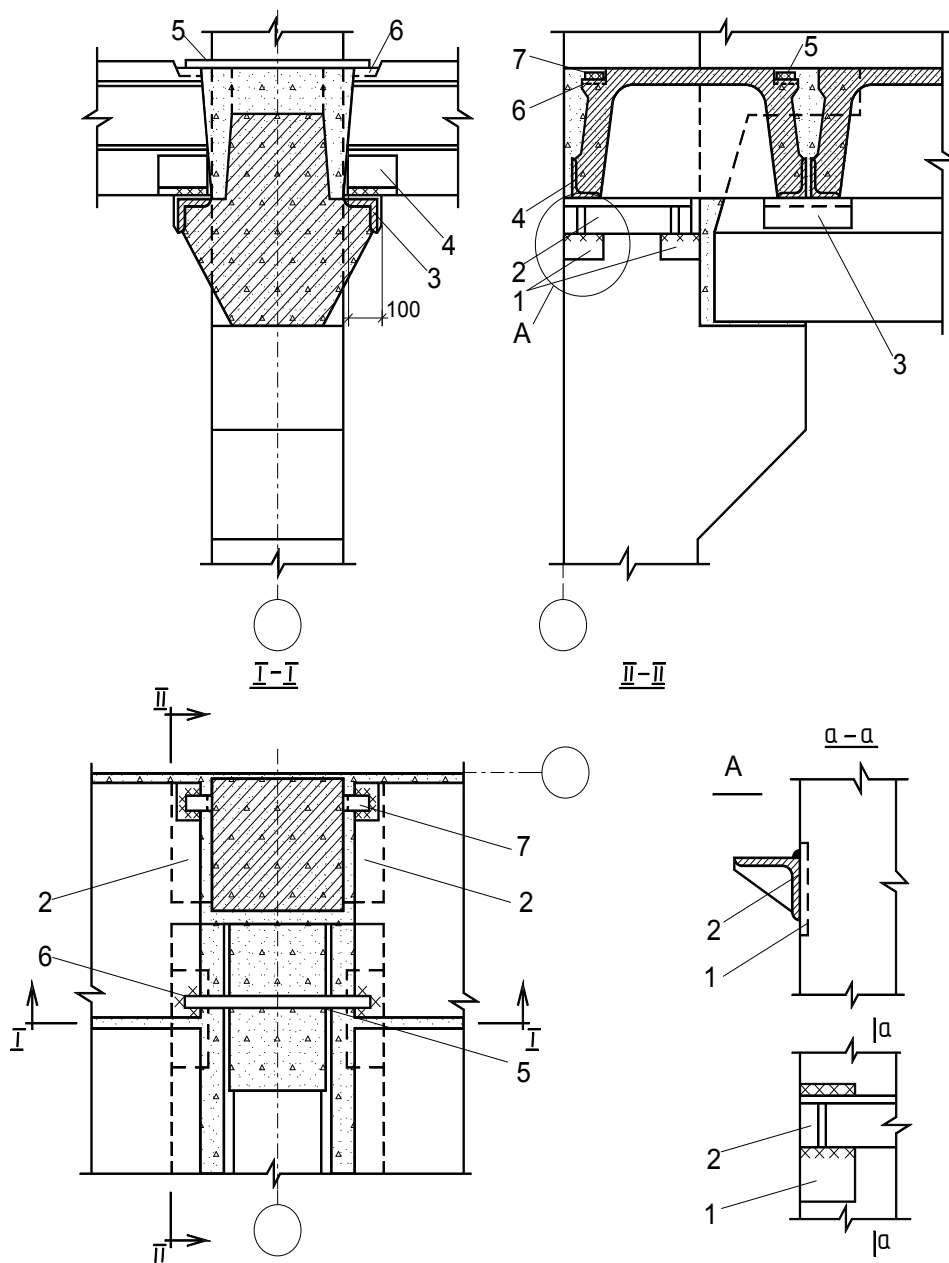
Деталі кріплення плит перекриття біля середньої колони при ригелях з полицями: 1, 3 – закладні деталі ригеля; 2 – столик з прокатного кутика; 4 – закладні деталі плити перекриття; 5 – накладка зі смужової сталі; 6 – верхні закладні деталі пристінних плит; 7 – коротиш з прокатного кутика, приварений врозпір з колоною
